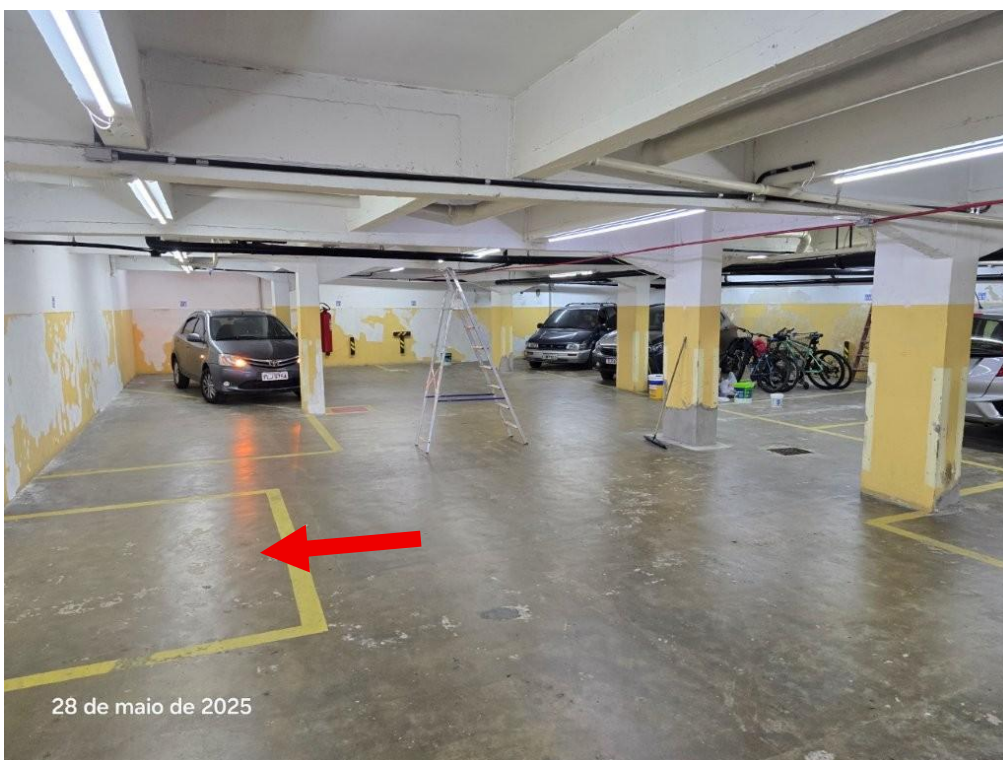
Vista geral da garagem – vaga referente ao imóvel avaliando em destaque - Subsolo
